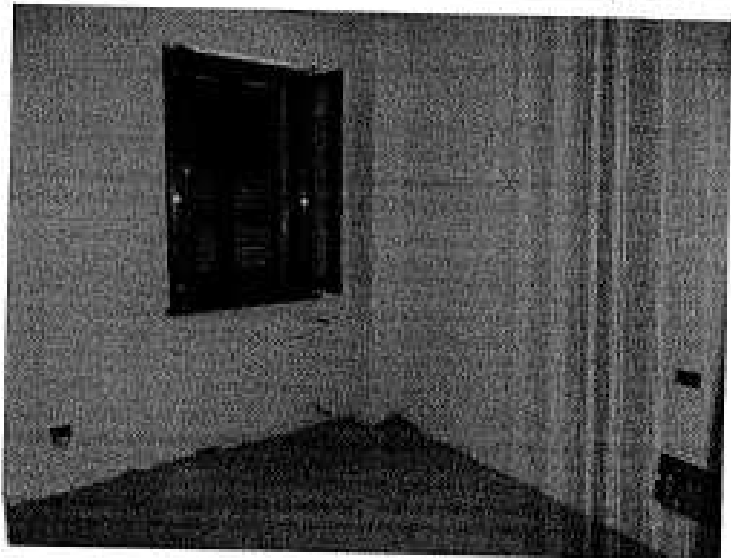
Blocco -d-: Bagno Villetta P.t:
